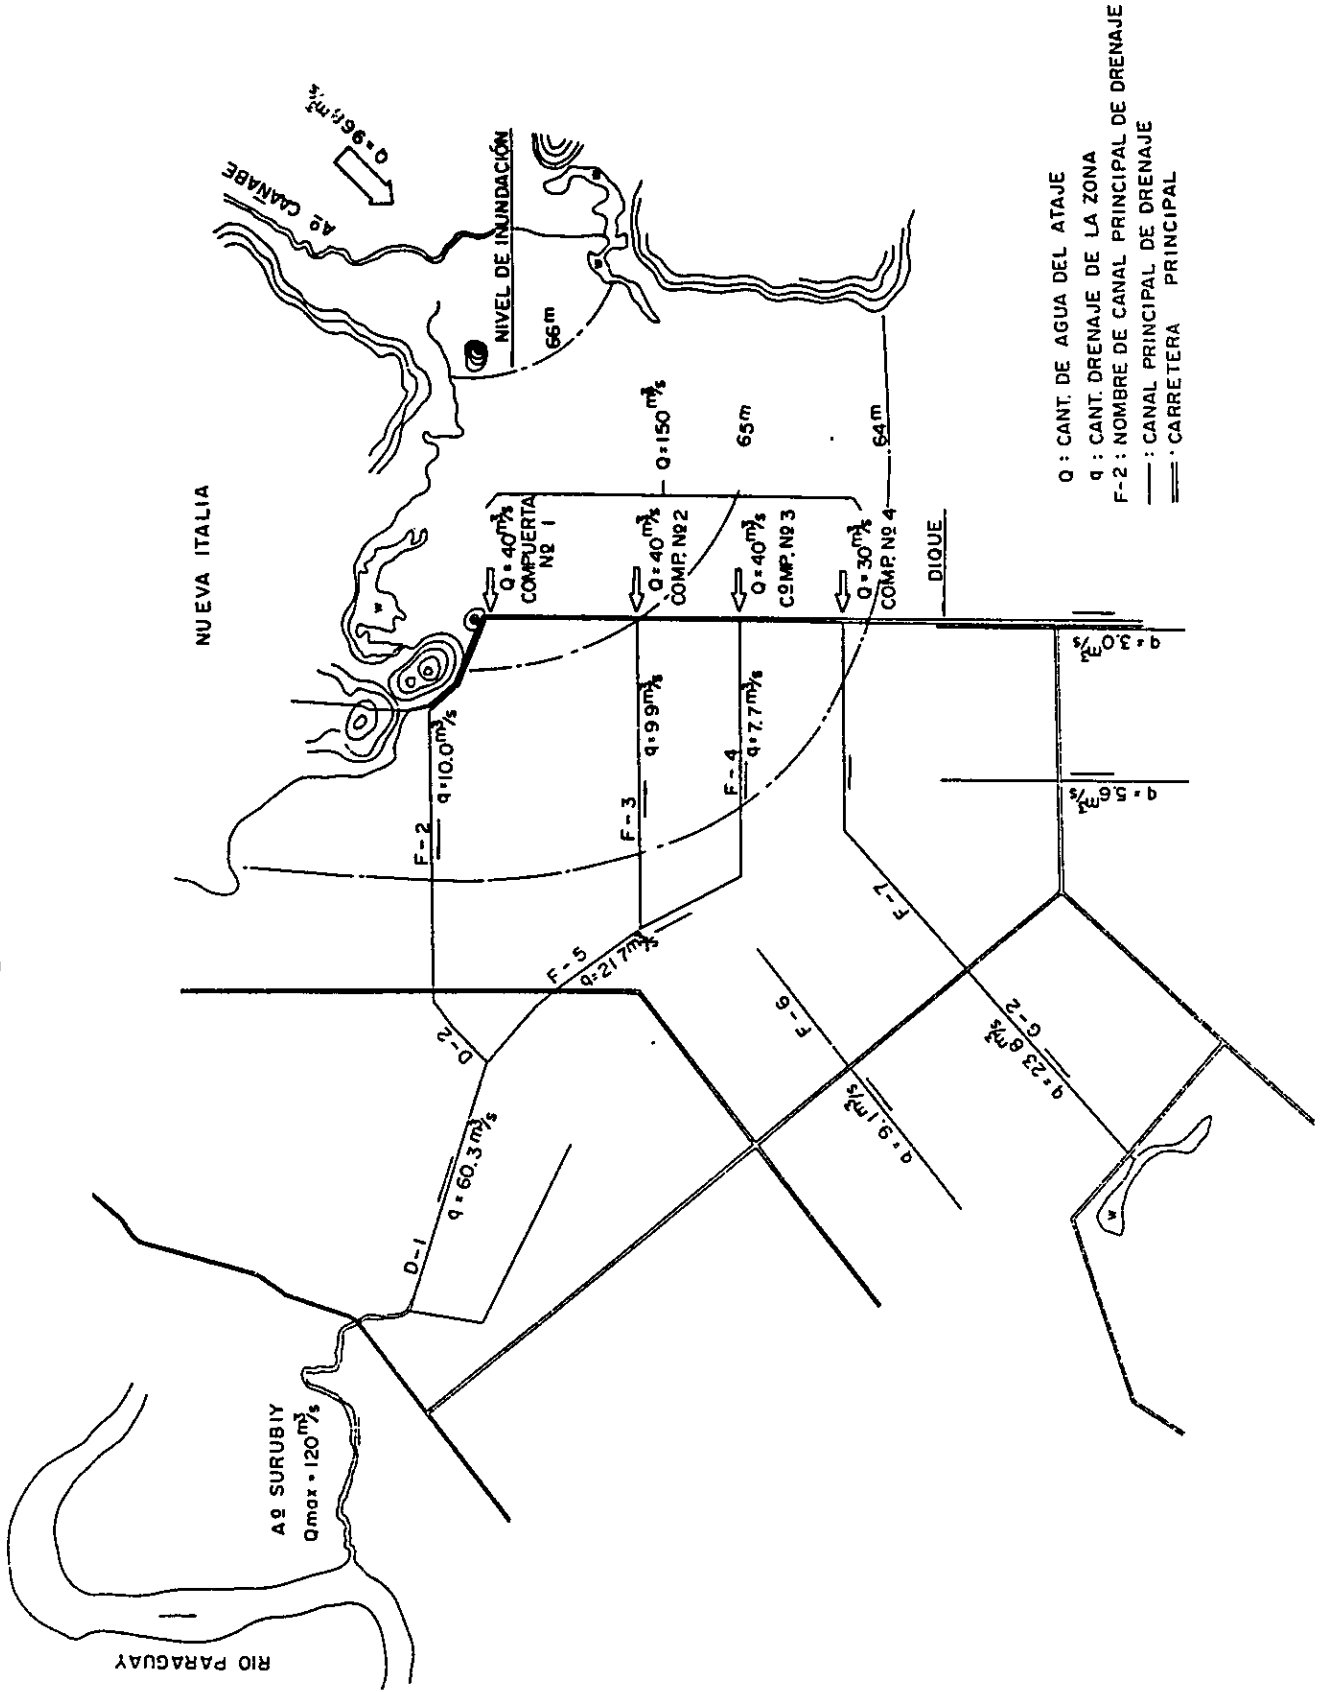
PLANO SISTEMATICO DE ARREGLO DELA CANT. DE DESAGUÉ (PLAN DE DIQUE AGUA ALTA)
